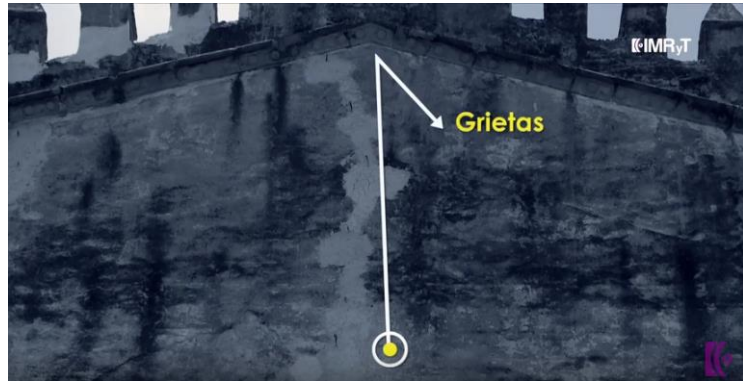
Trabajos de reconstrucción, inyección en grietas que aparecieron en la fachada después del sismo de 2017. (Monzalvo, 2019).
